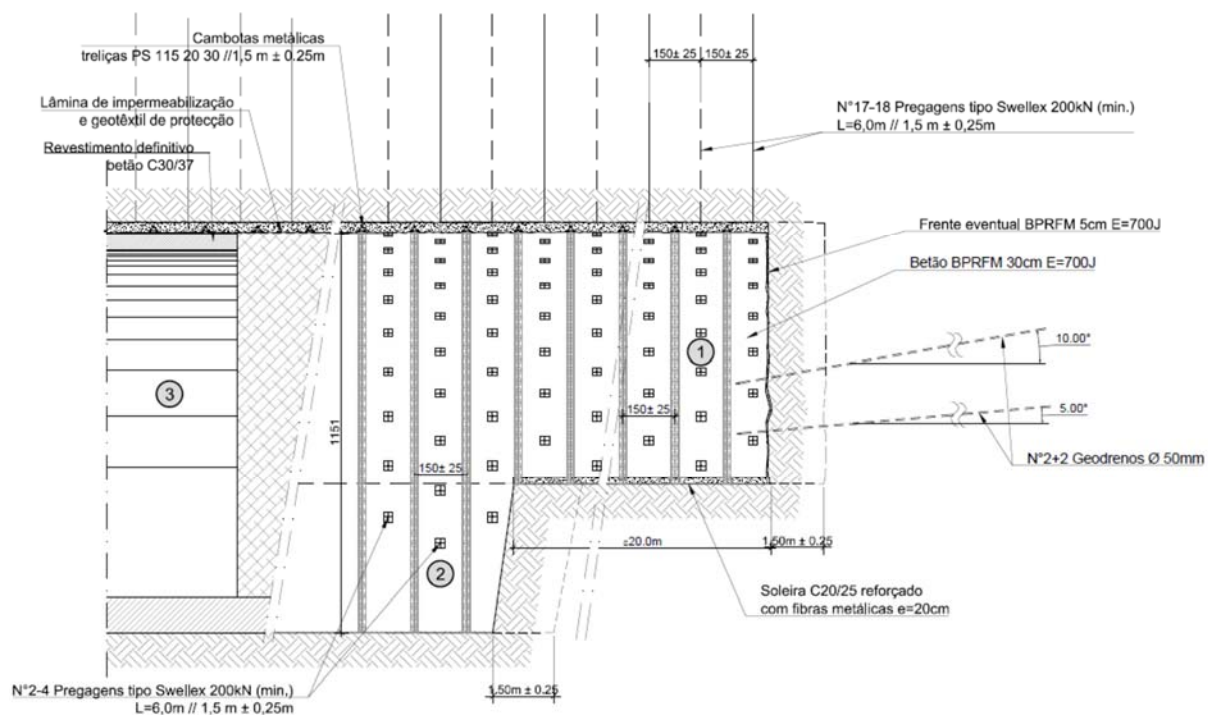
Corte longitudinal fase 1 e 2 – escavação e suporte primário em ZG2
